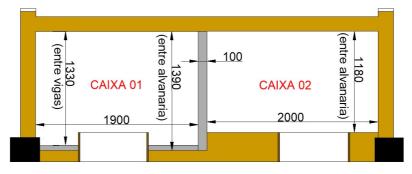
planta baixa das caixas de corrida existentes no prédio 03 do APERSUME,
